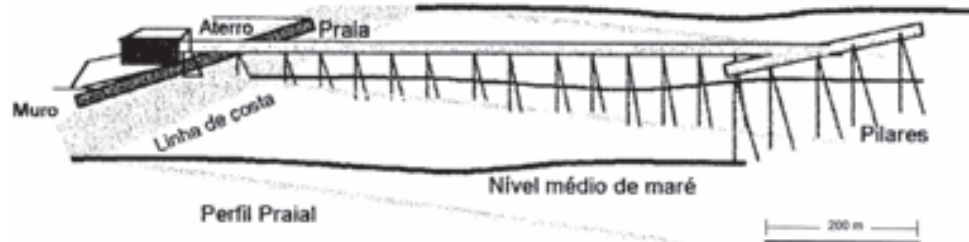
Perfil transversal da estrutura do Pier de Pesca (Farinnacio, 2000).
